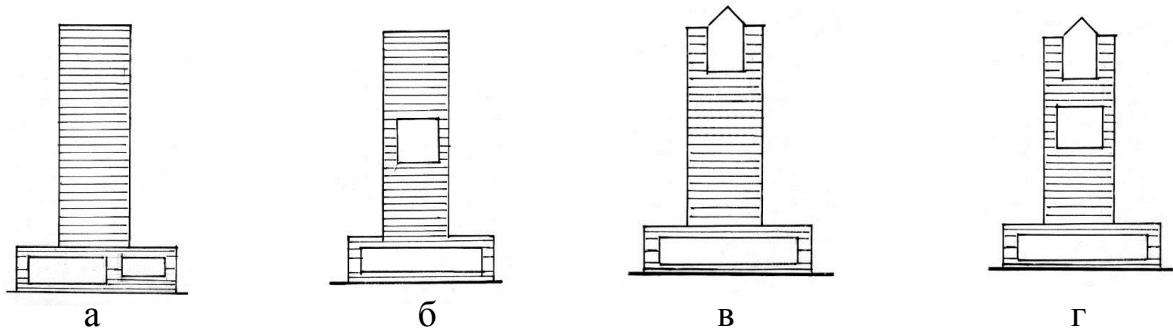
Варианты размещения зальных помещений в высотном здании:
